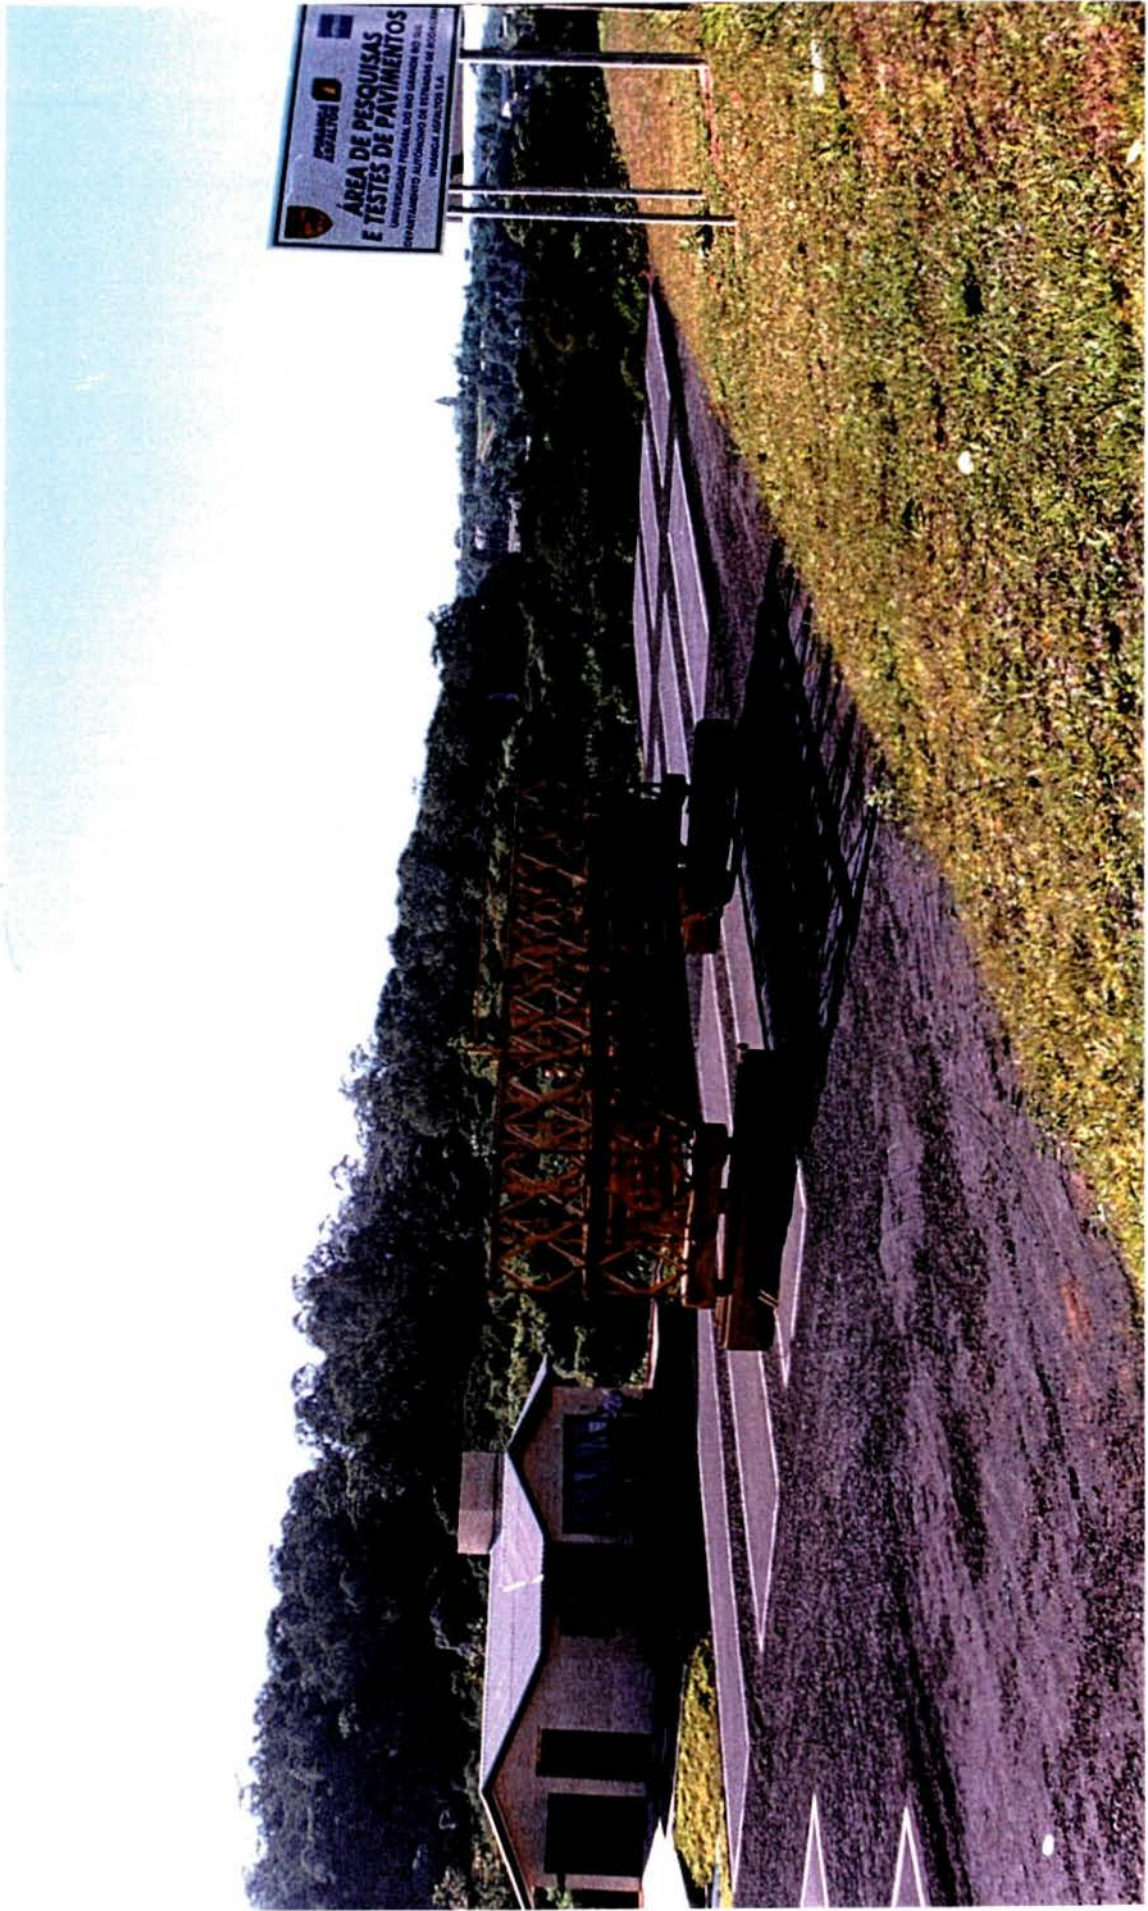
Vista da Área de Pesquisas e Testes de Pavimentos construída em Porto Alegre, RS
